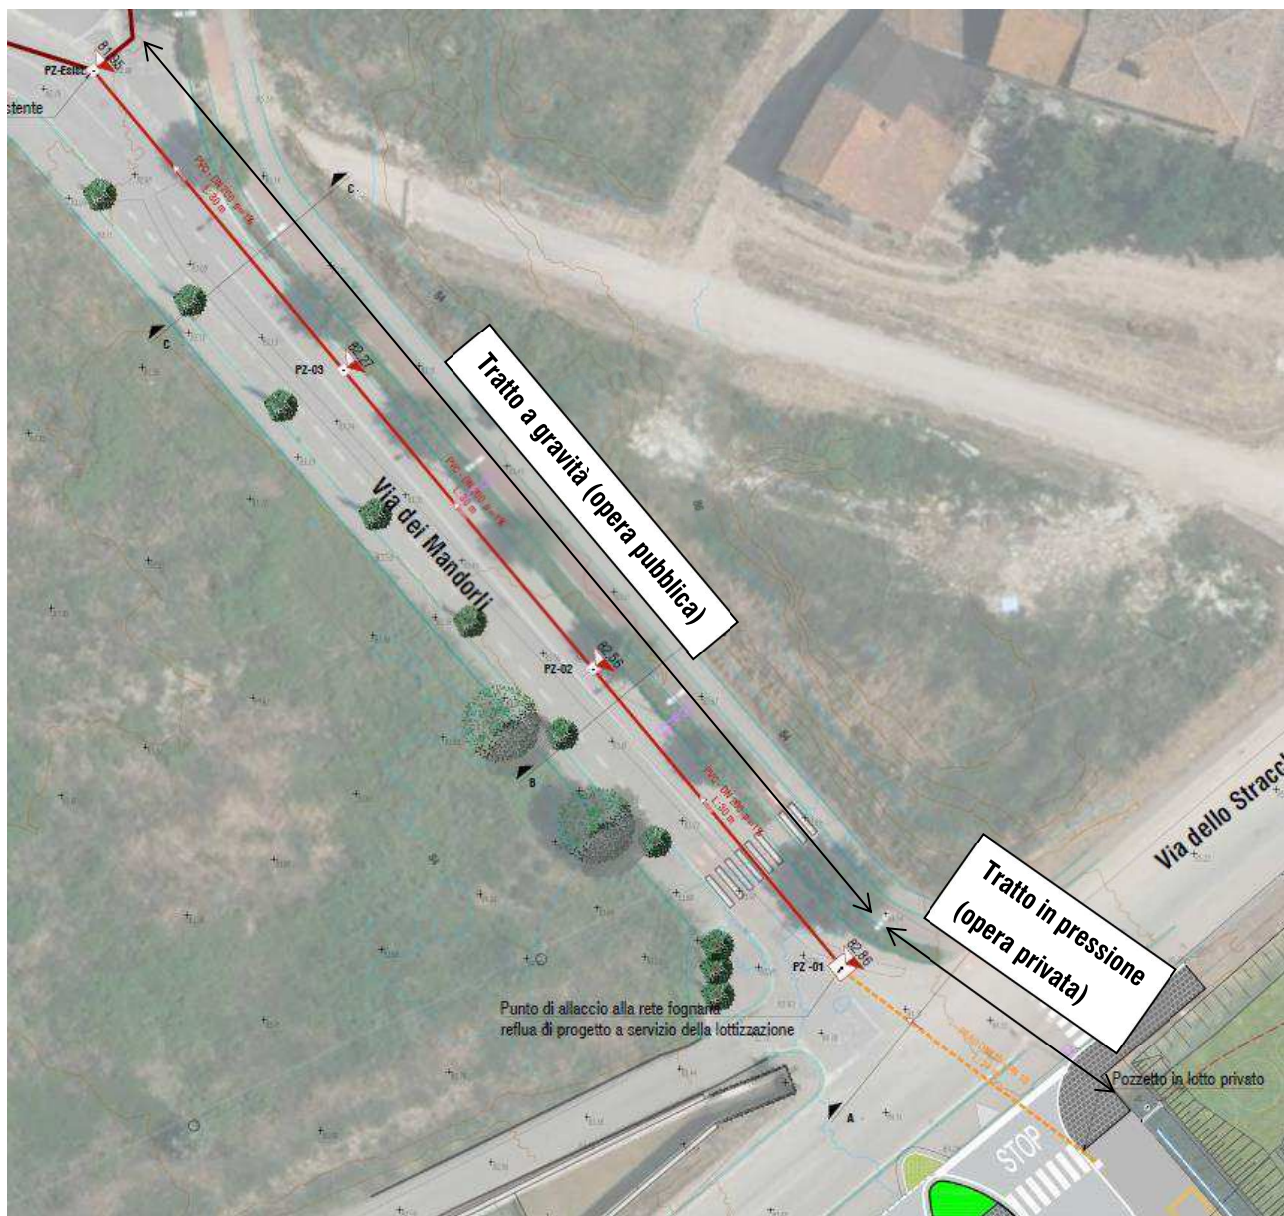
Stralcio planimetrico del punto di recapito acque reflue (rosso).
